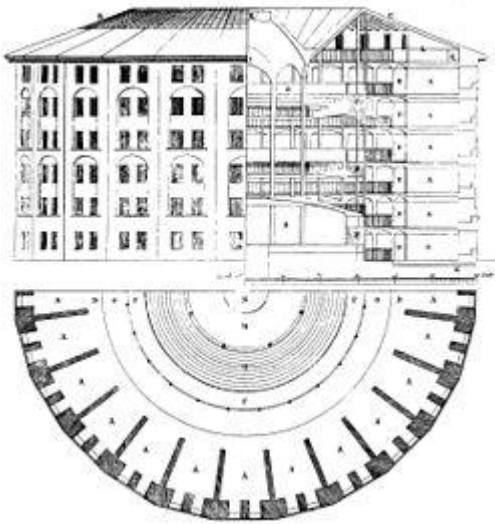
Centro penitenciario tipo Panóptico visto en fachada, corte y planta..
